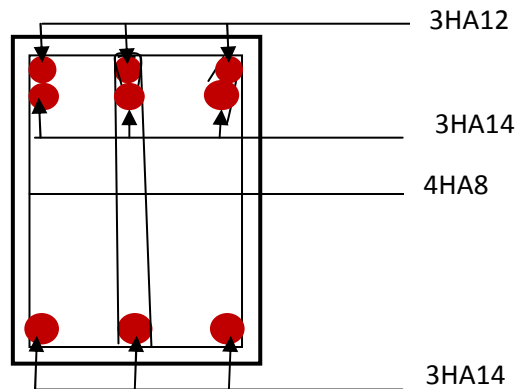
Ferrailage sur appuis d'une poutre principale.
